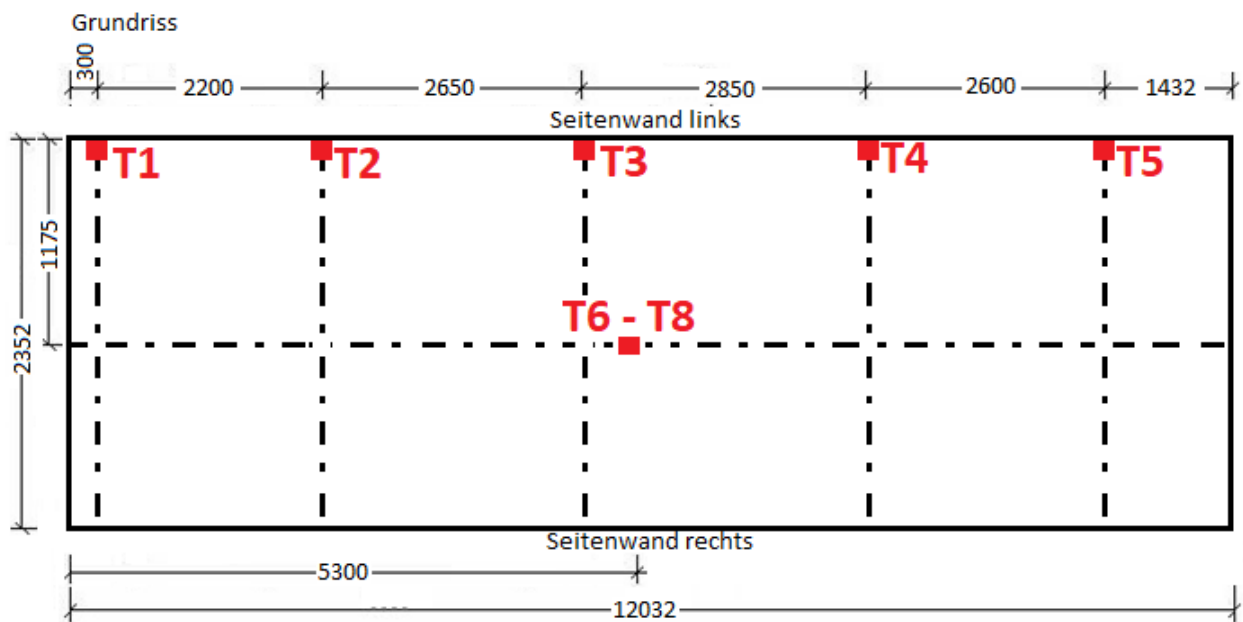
Anordnung Messtechnik Grundriss
